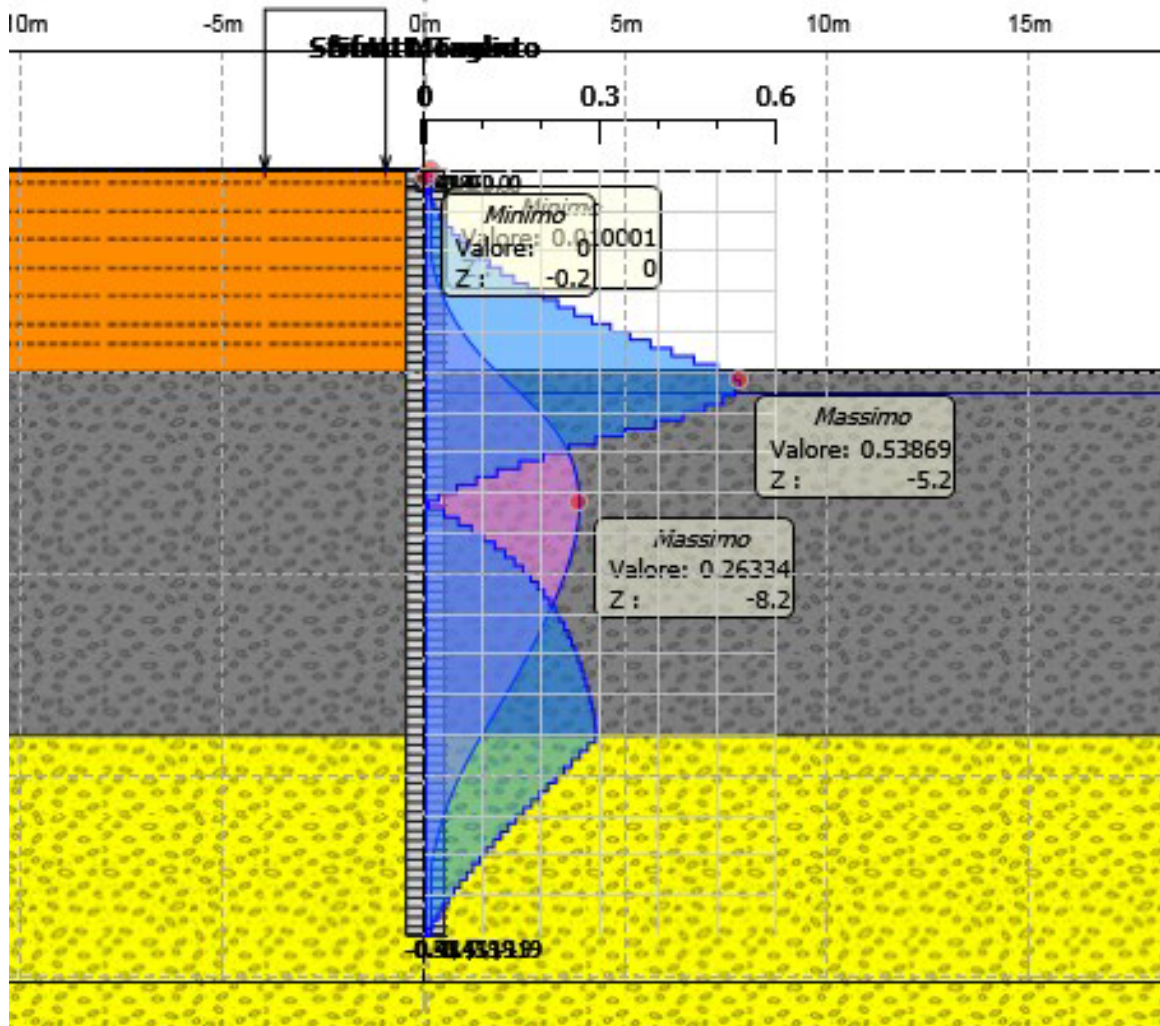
Spalle - coefficiente di sfruttamento sugli elementi strutturali – Verifica SLU (A2+M2+R1)
